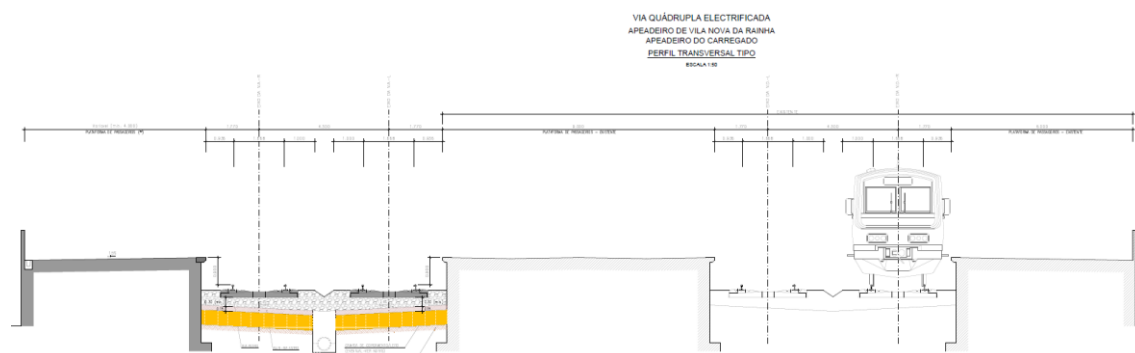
Perfil Transversal Tipo – Apeadeiros do Carregado e de Vila Nova da Rainha
